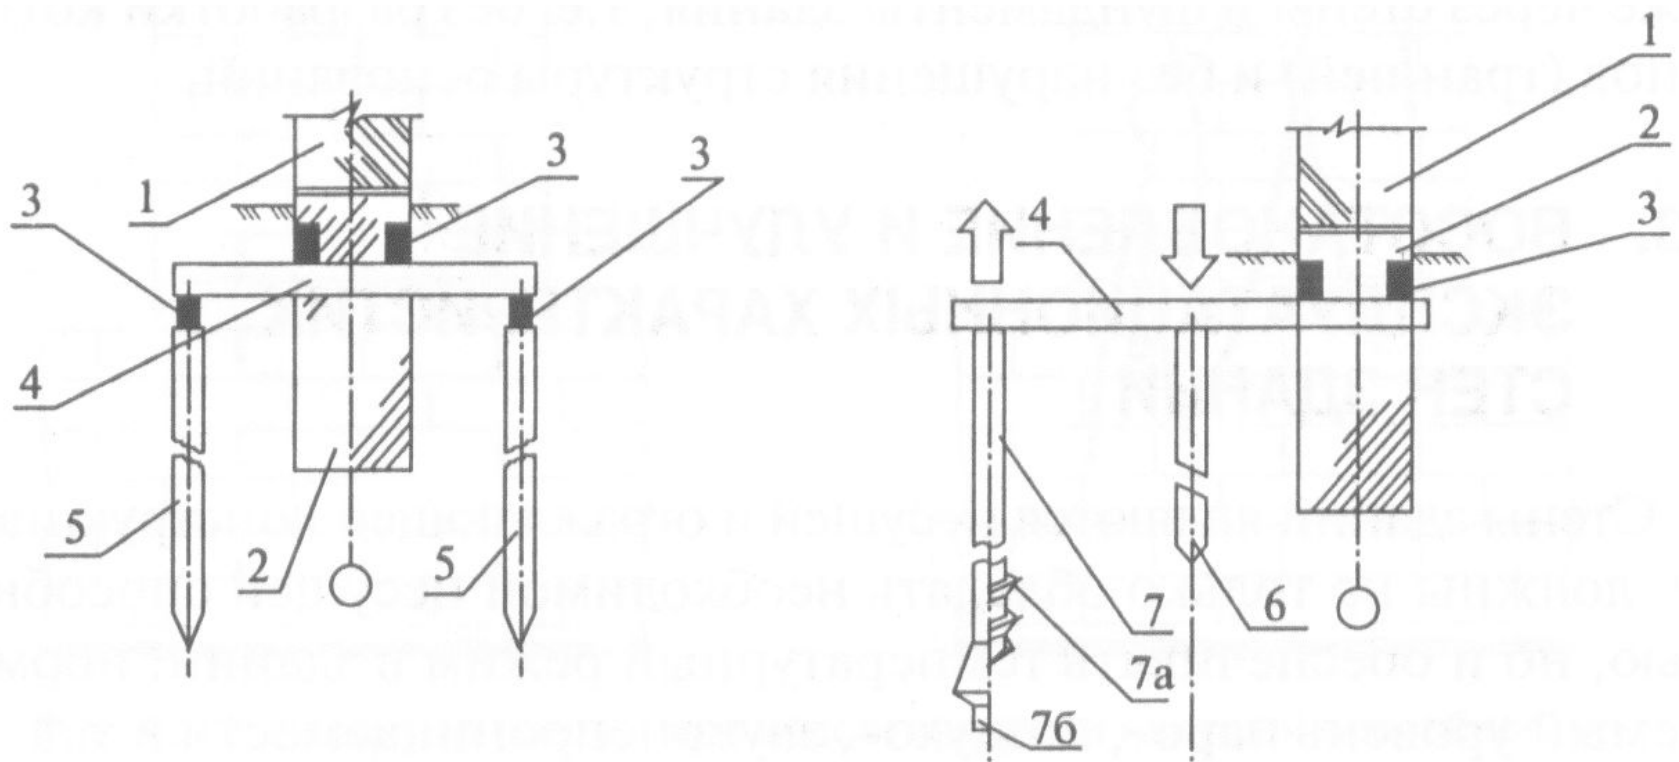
Схема усиления фундаментов передачей нагрузки на сваи:
